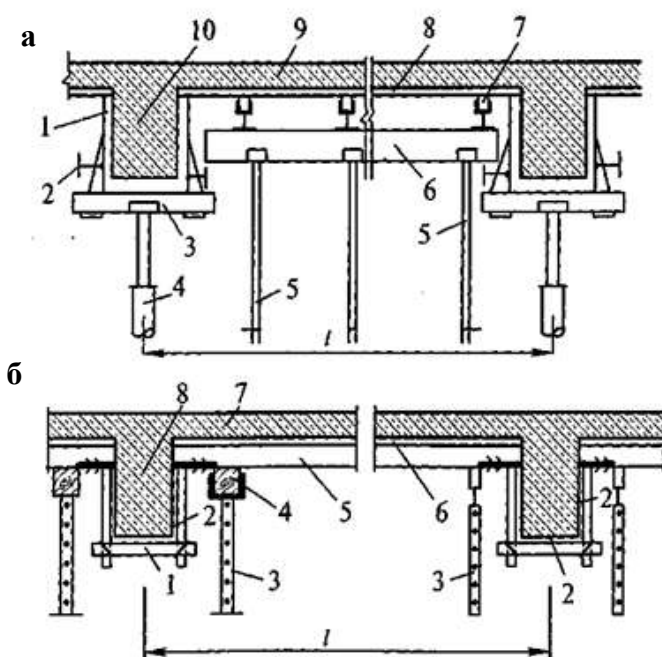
Схеми опалубних систем для влаштування балкових перекриттів: а – з підтримувальними стояками: 1 – бічний щит балки; 2 – гвинтовий домкрат; 3 – балочна струбцина; 4 – телескопічна стійка; 5 – підтримувальні стояки; 6 – опорна балка; 7 – ригель; 8 – палуба з фанери; 9 – плита перекриття; 10 – балка перекриття; б – з використанням підвісної опалубки балок: 1 – хомут; 2 – опалубні щити; 3 – телескопічні стояки; 4 – розподільна балка; 5 – прогін; 6 – палуба з фанери; 7 – плита перекриття; 8 – балка перекриття
